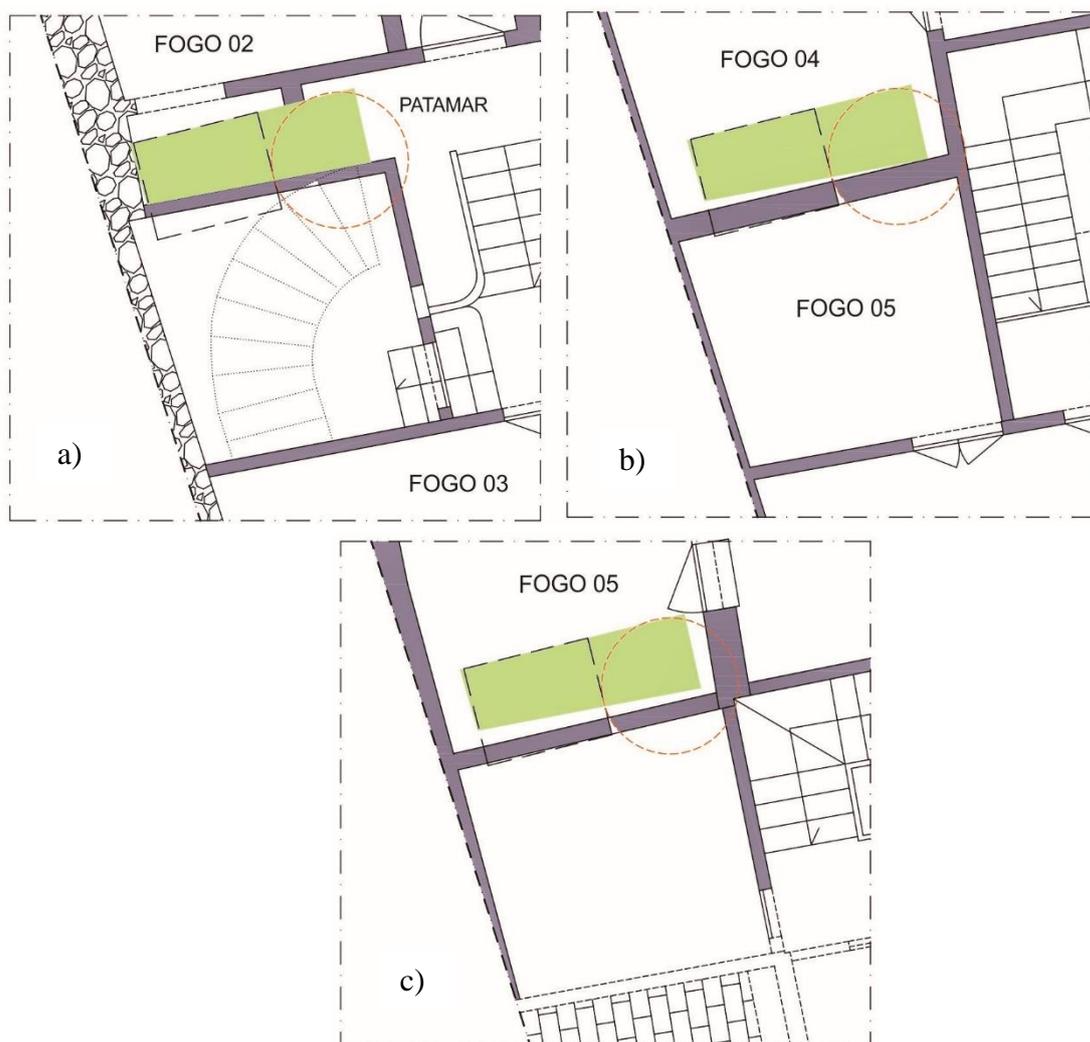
Sobreposição da instalação do elevador nos pavimentos superiores
